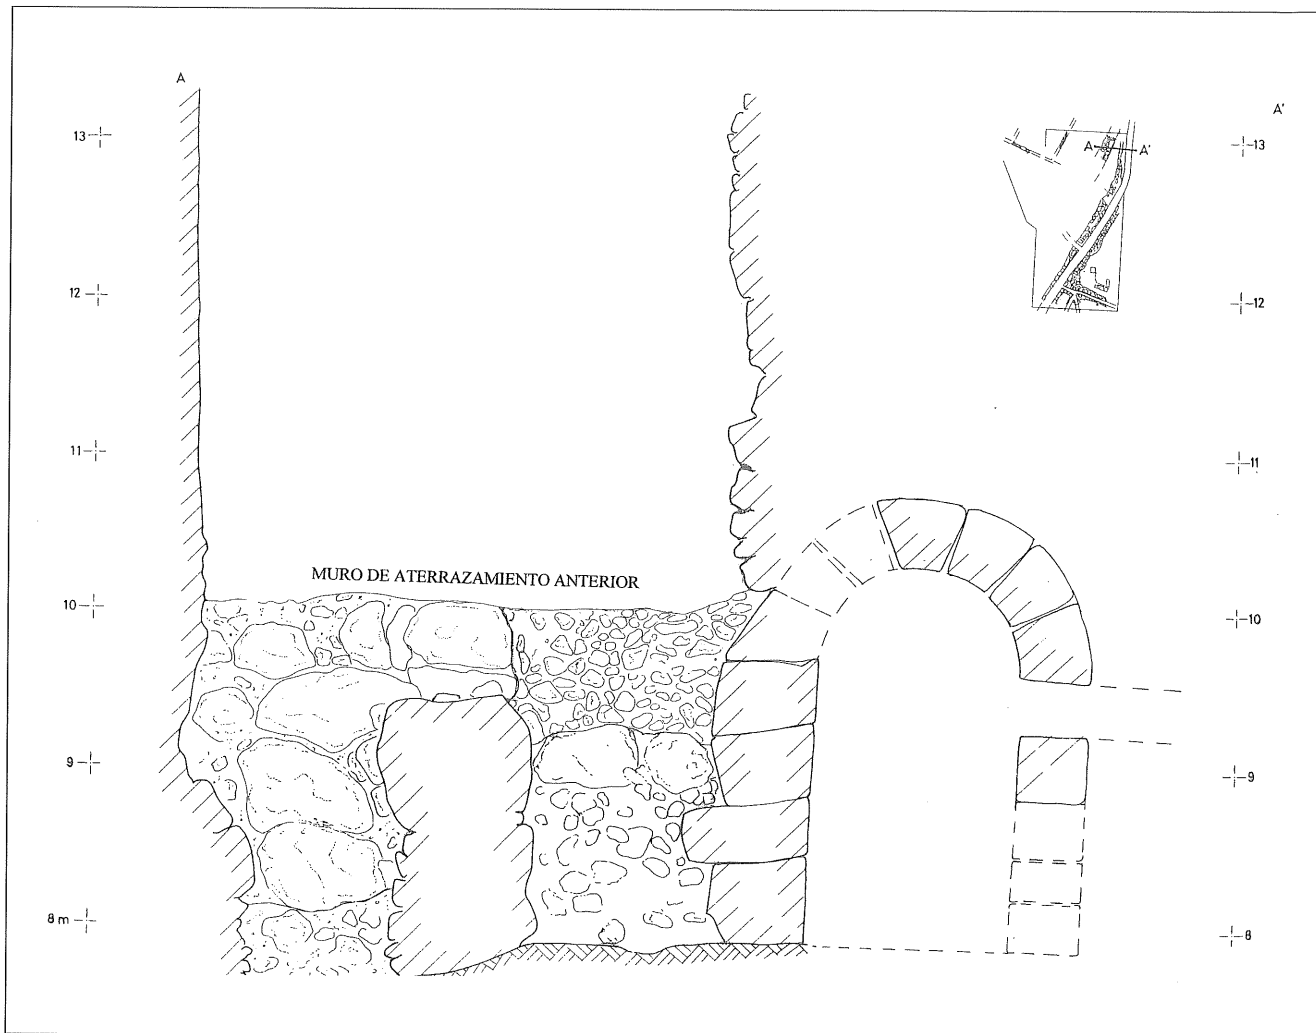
Alzado del muro de aterrazamiento anterior y sección restitutiva del gran colector (Planimetría CODEX).
